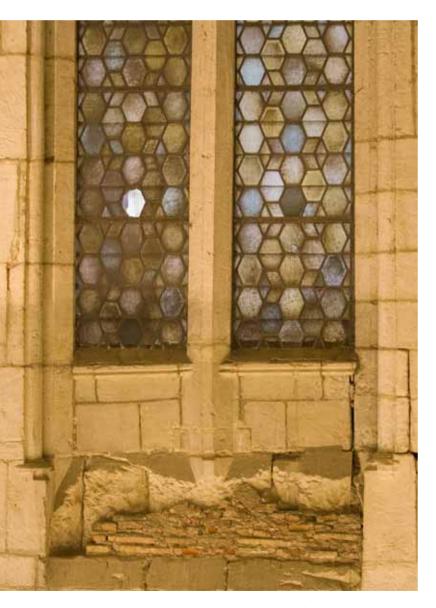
Detalle del estado de la parte inferior del ventanal sVI, afectado por grietas y antiguas reparaciones en ladrillo. (PCP).
